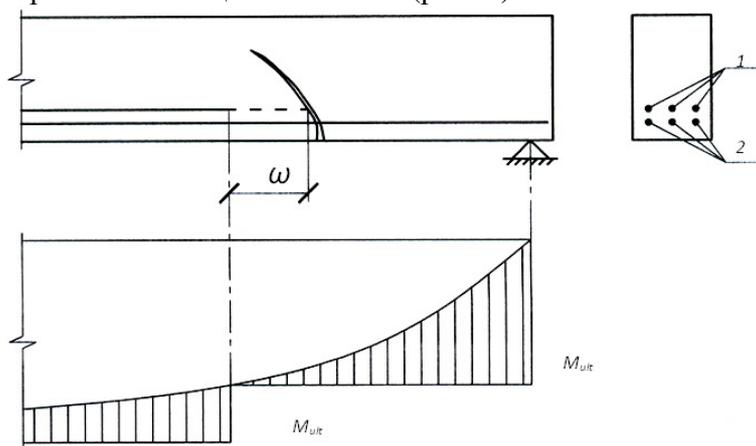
Схема армирования железобетонной балки со смешанным армированием
